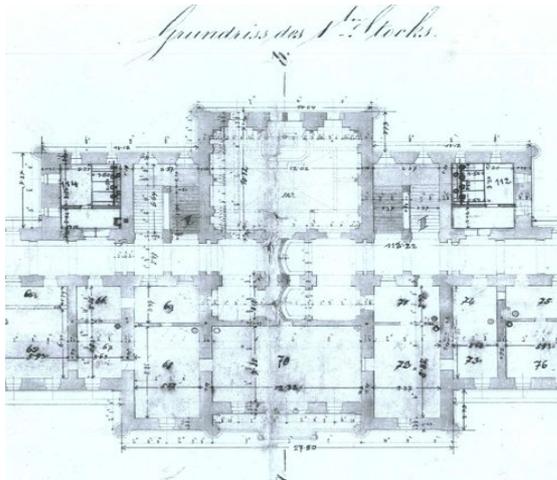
k. k. Kadetteninstitut, Mitteltrakt, Grundriss 1. Stock, Ausschnitt, 1874
